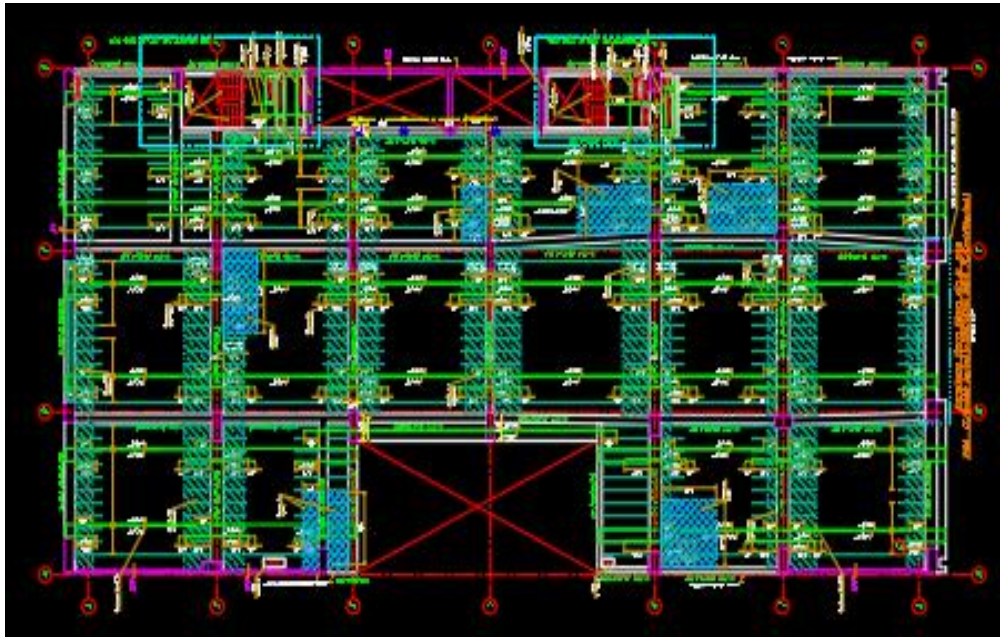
Planta típica de encofrado del 4to al 12vo Nivel
